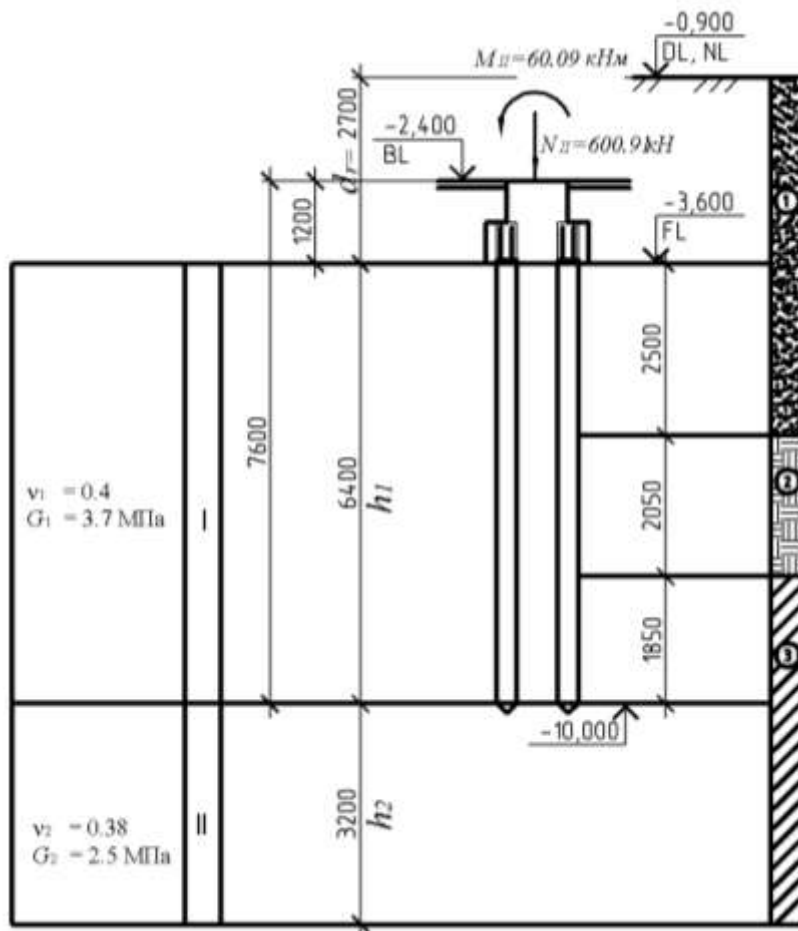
Расчетная схема к примеру 9.2.2
